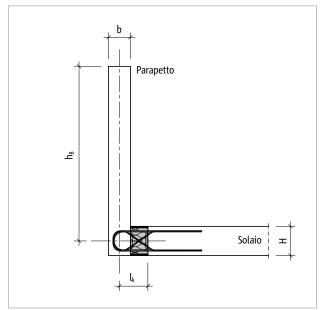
Schöck Isokorb® XT tipo AP: schema statico con altezza del parapetto h.
